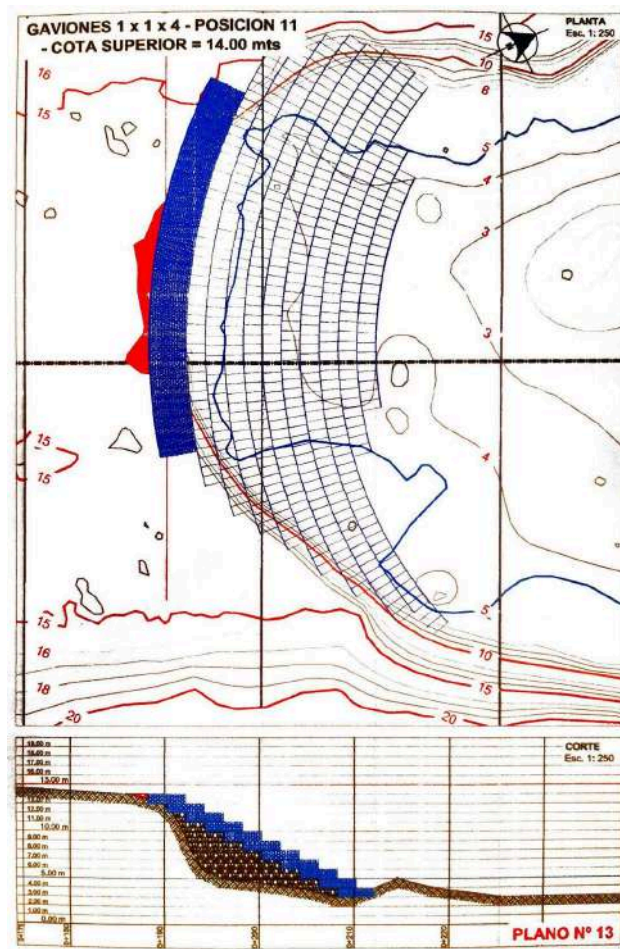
Planta y corte de la obra de emergencia para la estabilización de la cascada del Arroyo Saladillo. Dirección Provincial de Vialidad Santa Fe.
